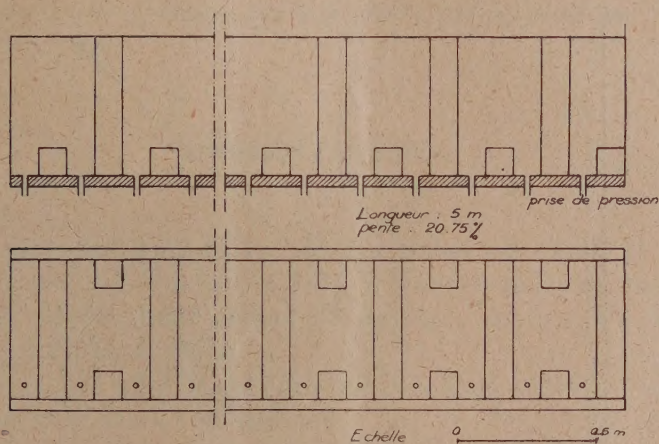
Disposition de l'échelle à poissons rabattue sur un plan horizontal.
